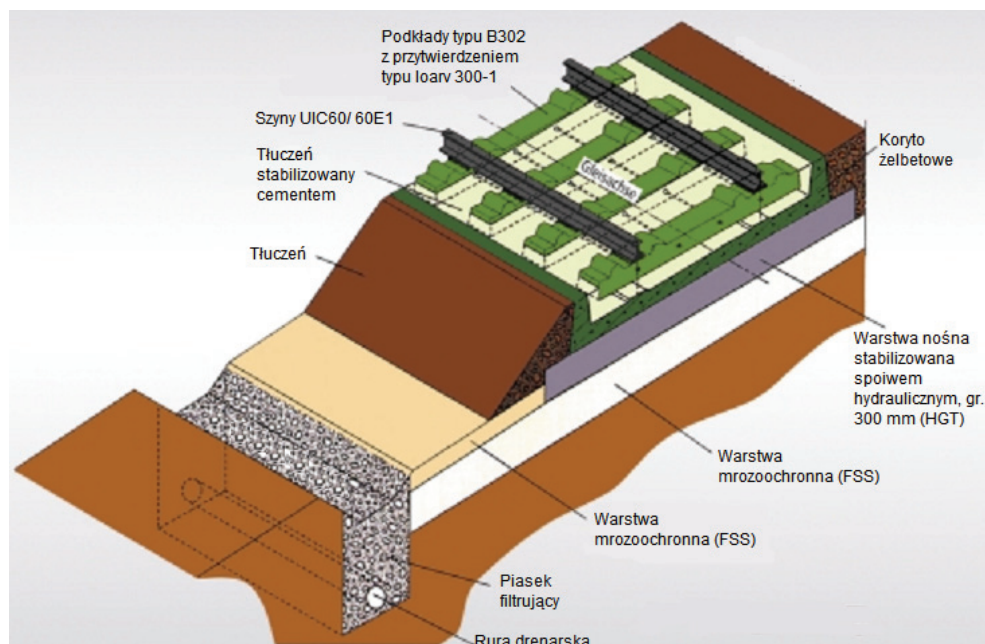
Typowa konstrukcja nawierzchni Züblin [11]
